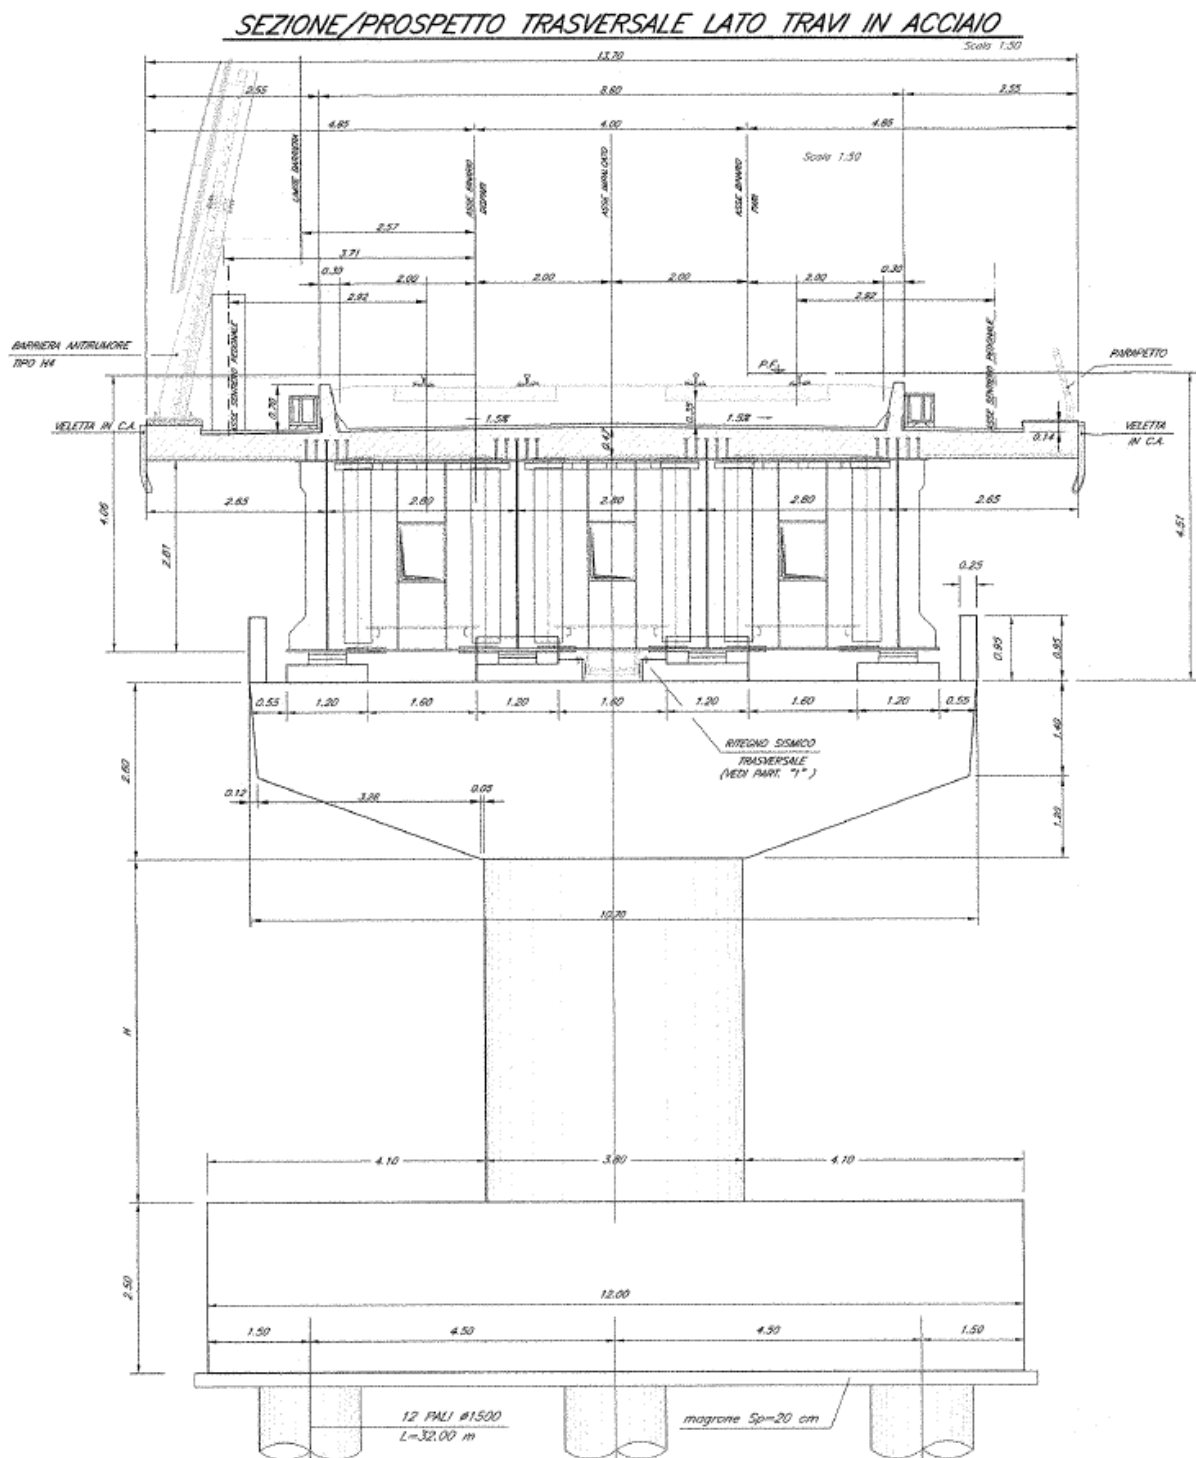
Pila, prospetto frontale – Impalcato in struttura mista acciaio calcestruzzo [m]
